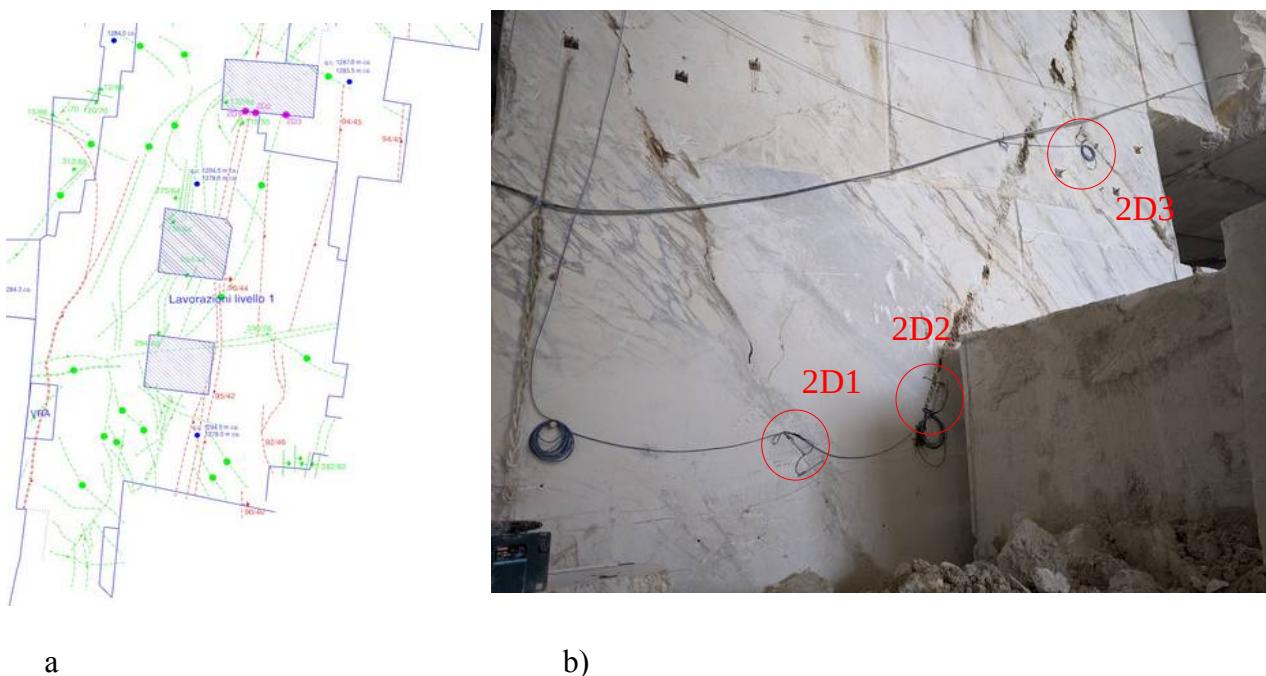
a), planimetria dell'area di coltivazione illustrante il posizionamento delle postazioni fessurometriche (cerchiate in rosso) b), illustrazione fotografica della parete su cui sono stati montati i fessurometri
